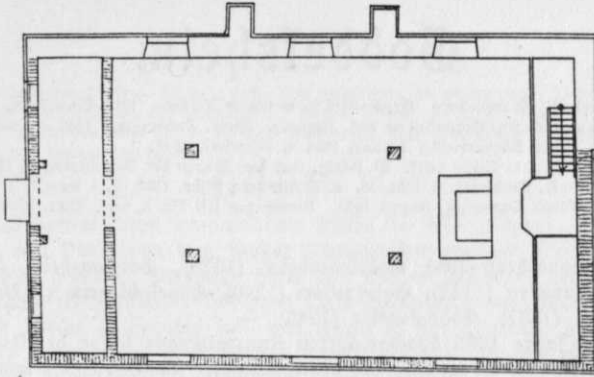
Giebringhausen, Grundriß der Kirche. 1:200
